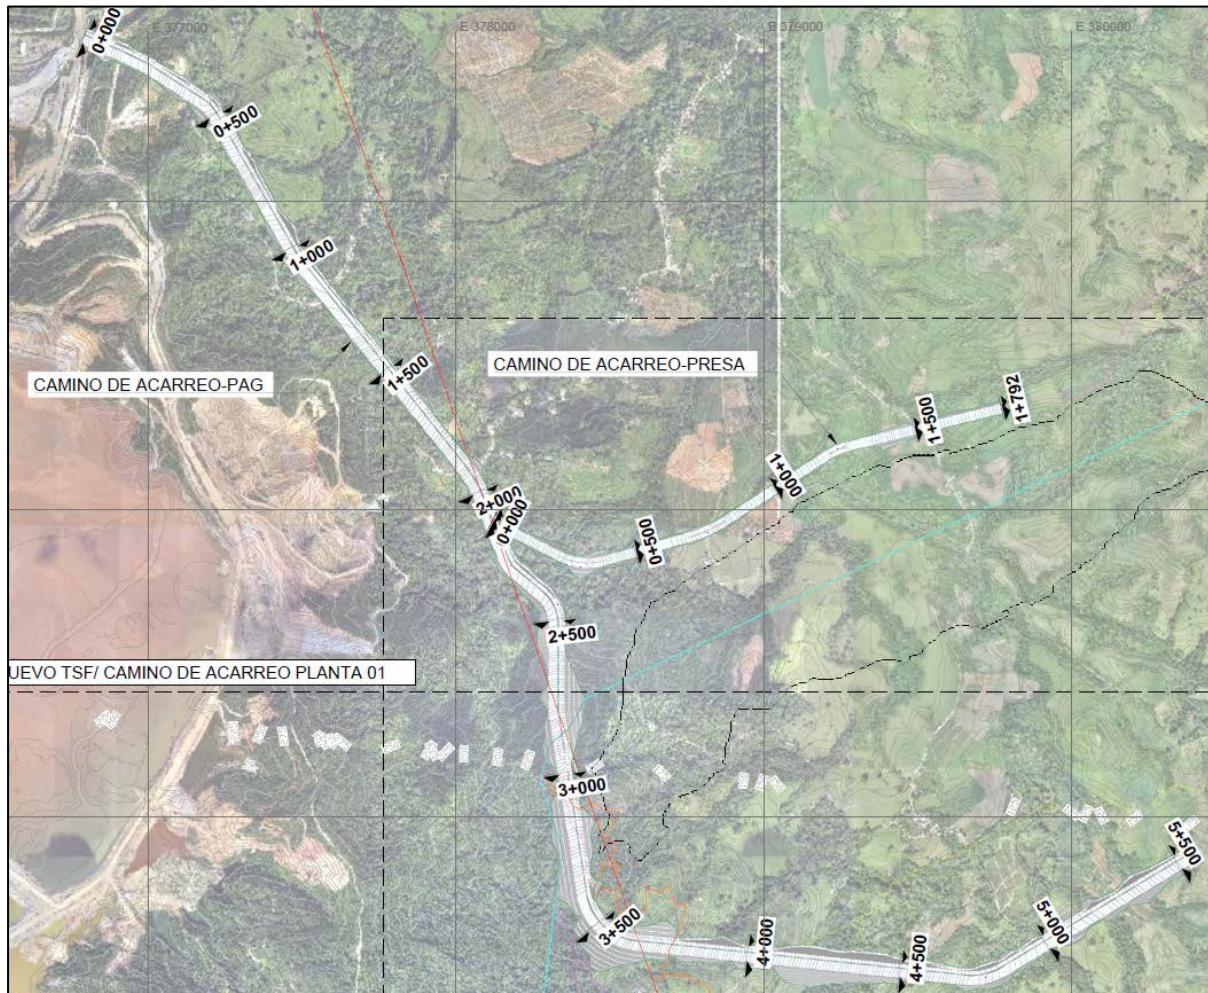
Vista en planta de los caminos de acarreo PAG
